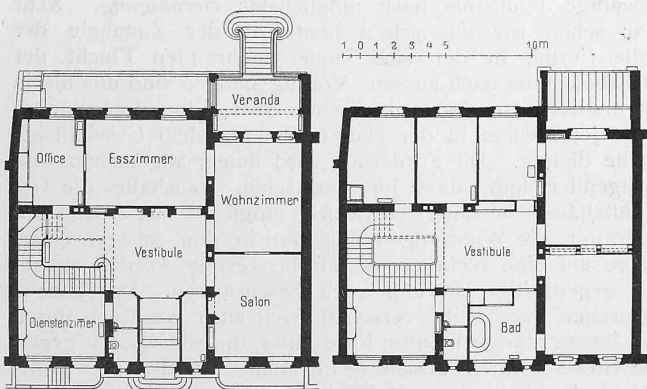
und 25. Grundrisse des Familienhauses an der Hartstrasse.
